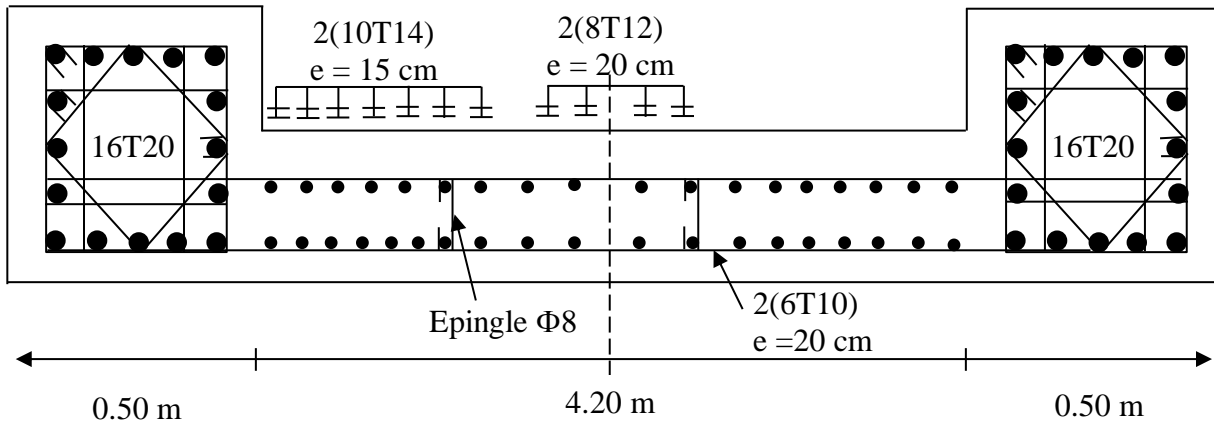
Schéma de ferrailage du voile rectangulaire avec deux poteaux.
